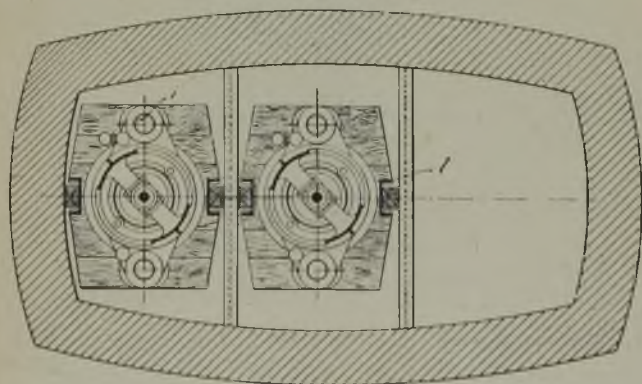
Grundrissliche Anordnung der Senk-pumpen im Schacht.
